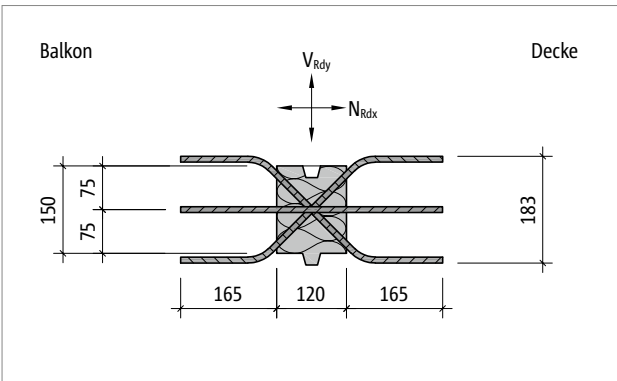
Schöck Isokorb® XT Typ H-VV1-NN1: Produktgrundriss
